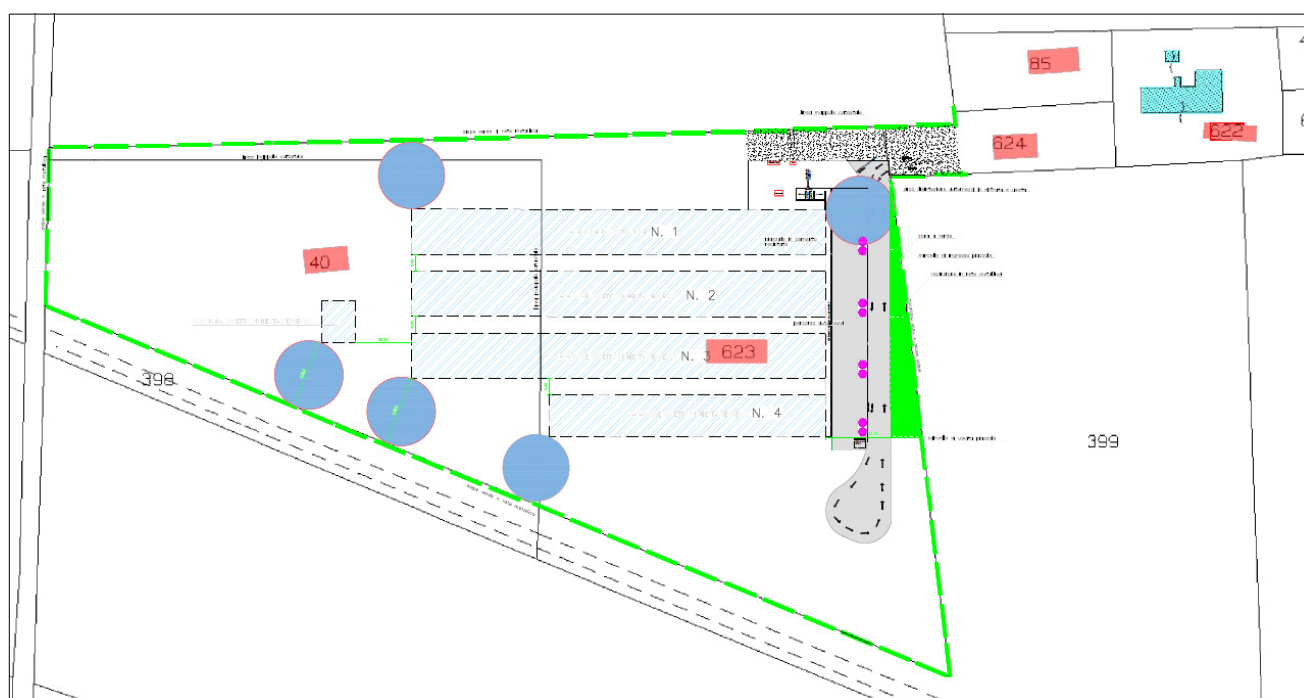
Estratto planimetrico da tavola di progetto TAV 4 Planimetria insediamento.
